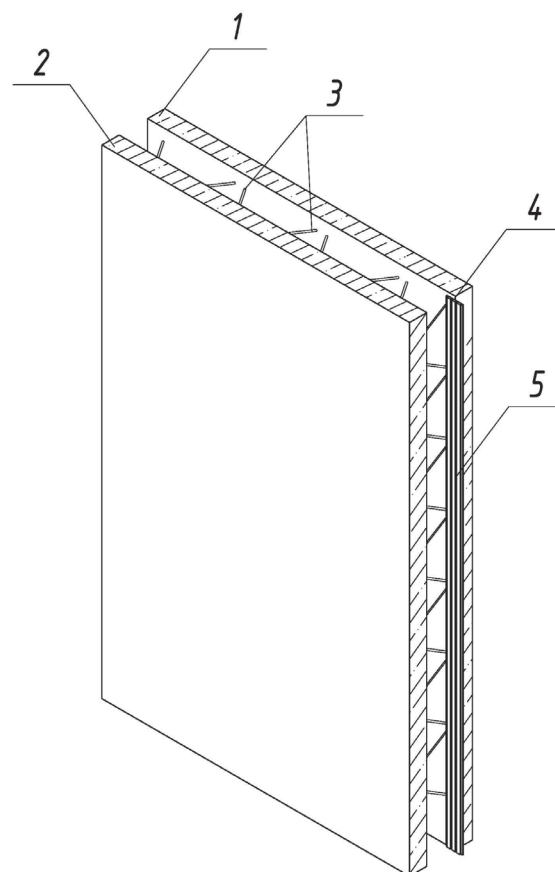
Конструктивное решение несъемной железобетонной стеновой опалубки для стен подвалов и заглубленных этажей гражданских зданий:
